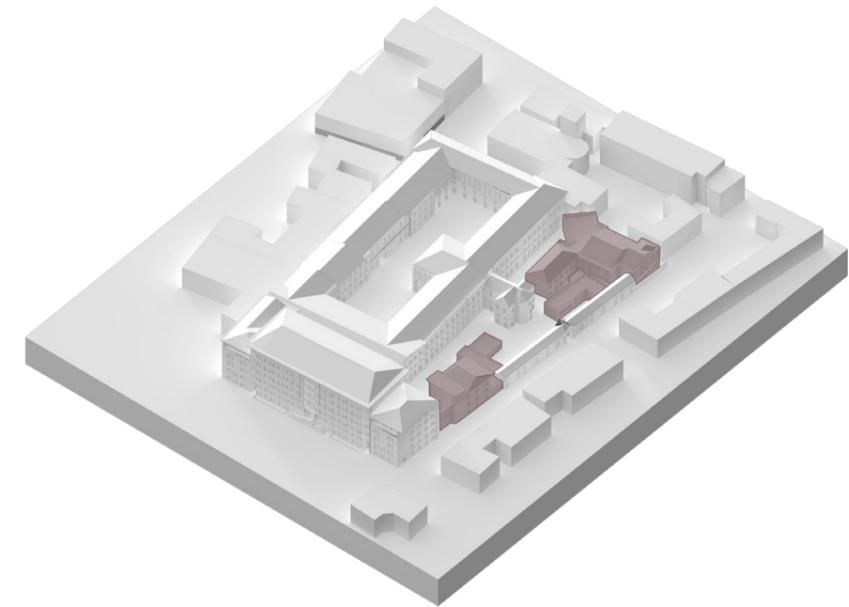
Schema riassuntivo degli interventi di demolizione Step 1
